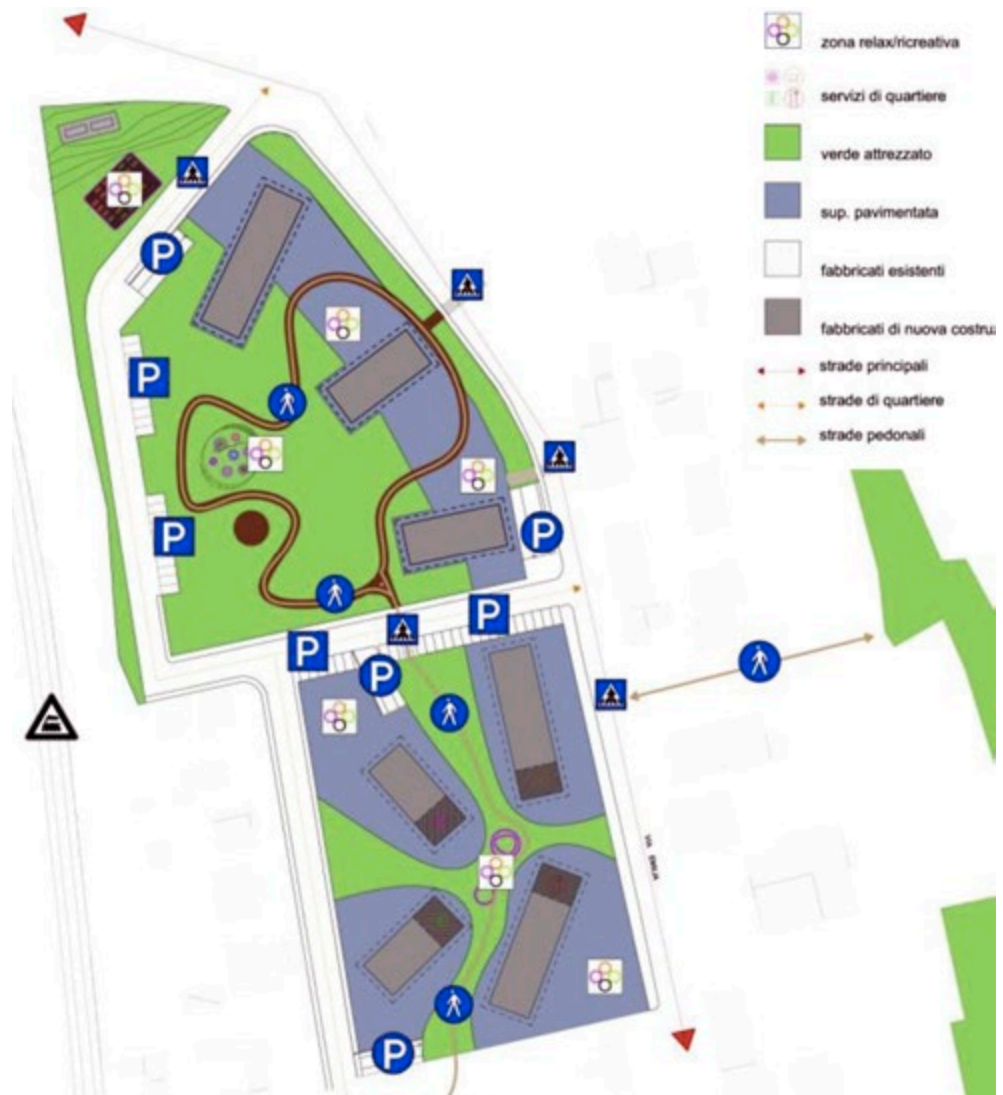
Masterplan "Per un quartiere sostenibile": planimetria.
